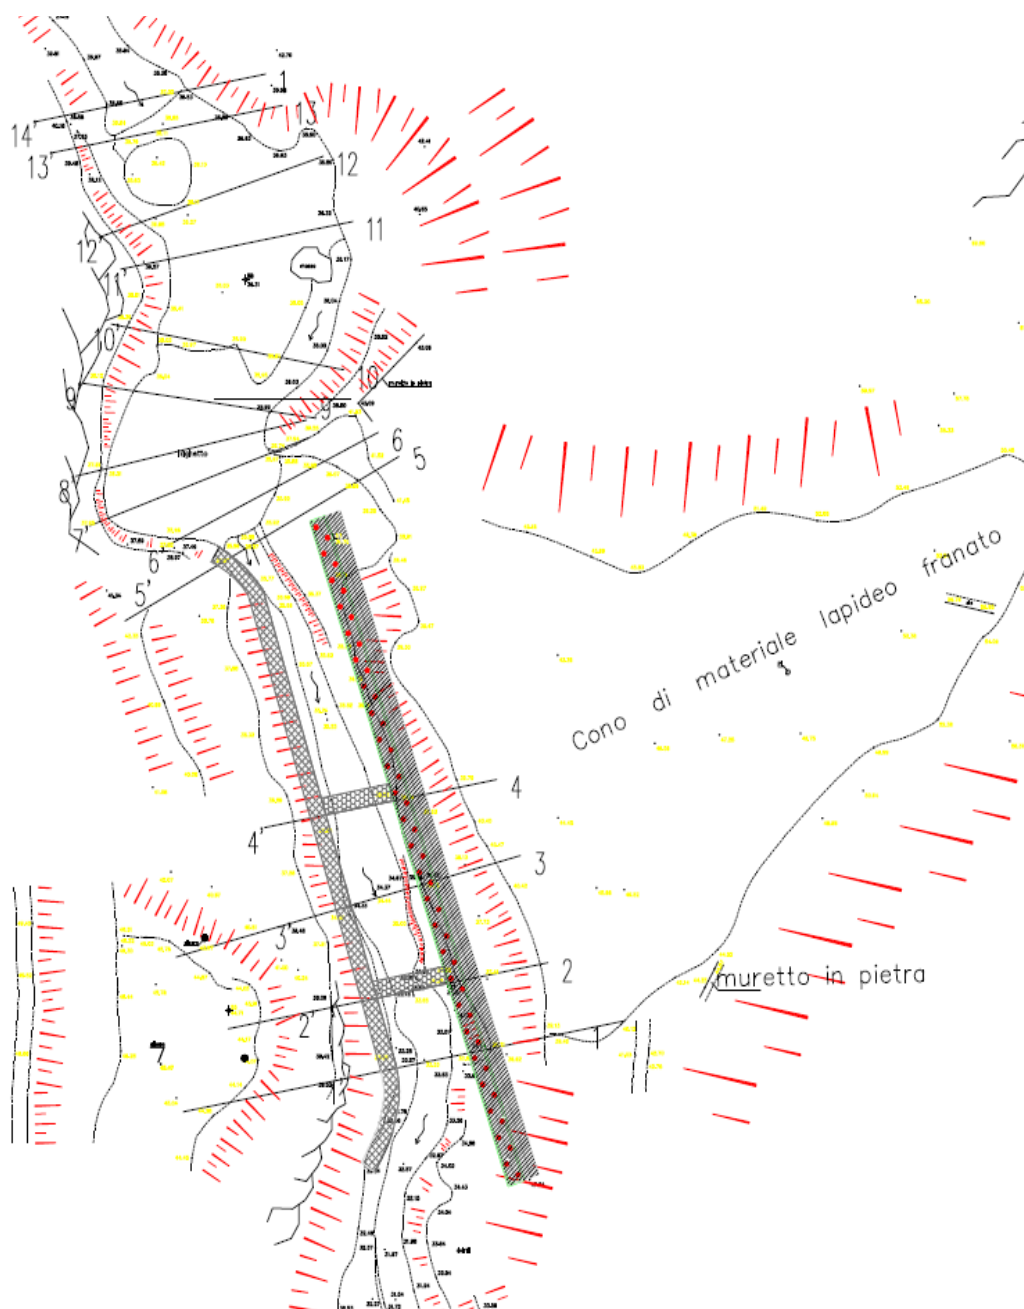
localizzazione sezioni idrauliche. Planimetria di Stato di Progetto
